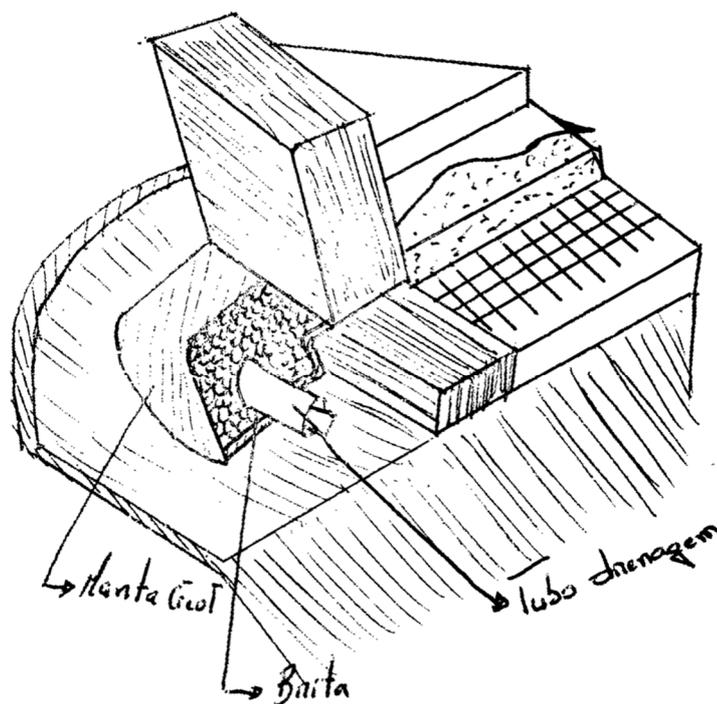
Impermeabilização e colocação de dreno (Fonte: Autor)
